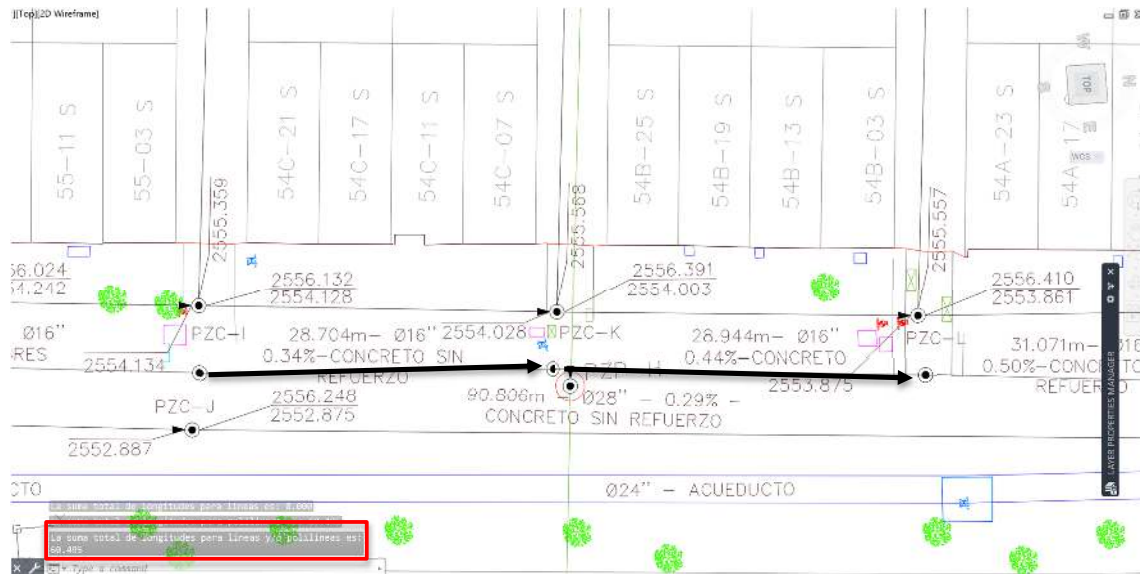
Cuantificación de longitud alcantarillado pluvial D 24\".
